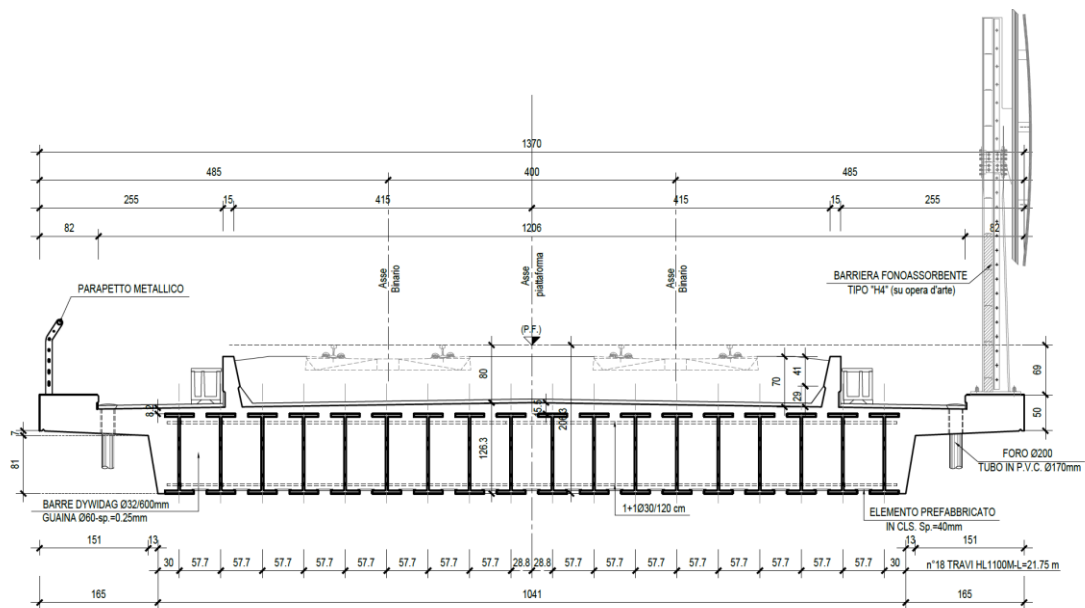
Sezione trasversale corrente – impalcato L=22m
